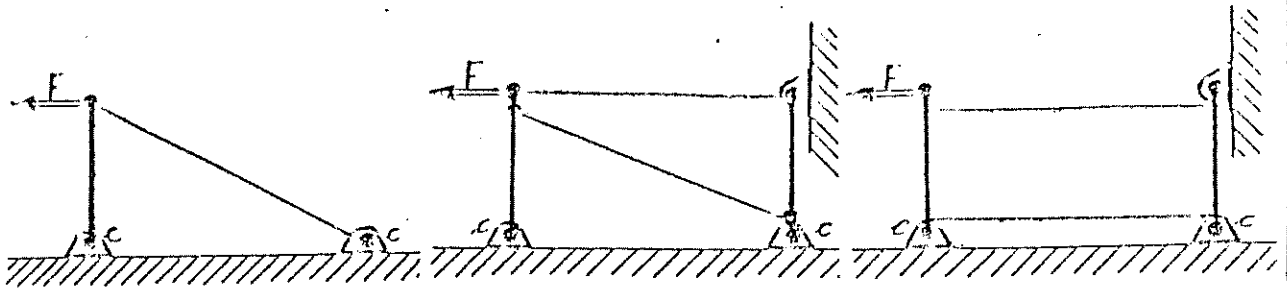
Prova di rigidità di schema funzionale in pianta (trazione)
